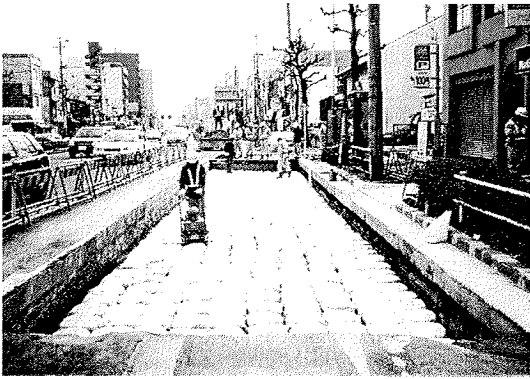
幹線道路での土のう積層体を用いた防振工の施工の様子
